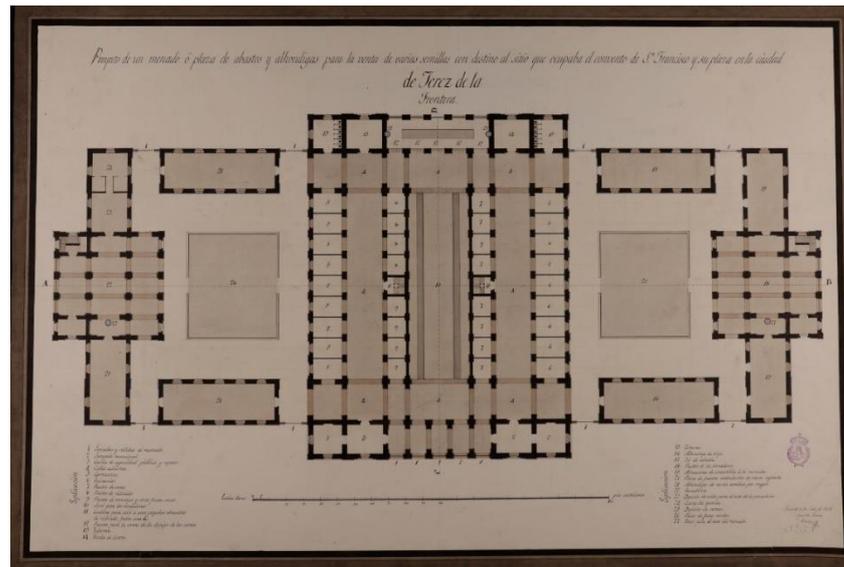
Planta arquitectónica de mercado de abastos de Jerez
